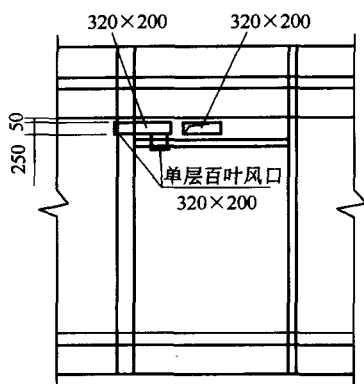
高层建筑标准层采用全热交换器处理新风的新风布置平面图
